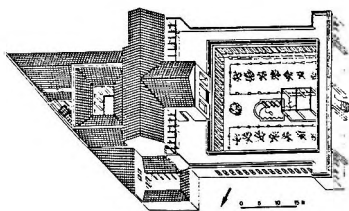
idem. Villa de Diomede a) Planimetria geral; b) reconstrução (Vos,1982:241).
